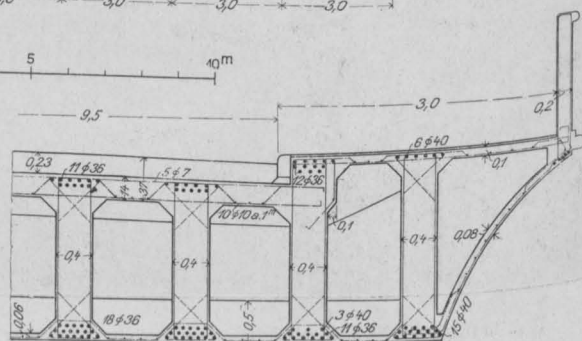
Brückenquerschnitt mit Bewehrung.
